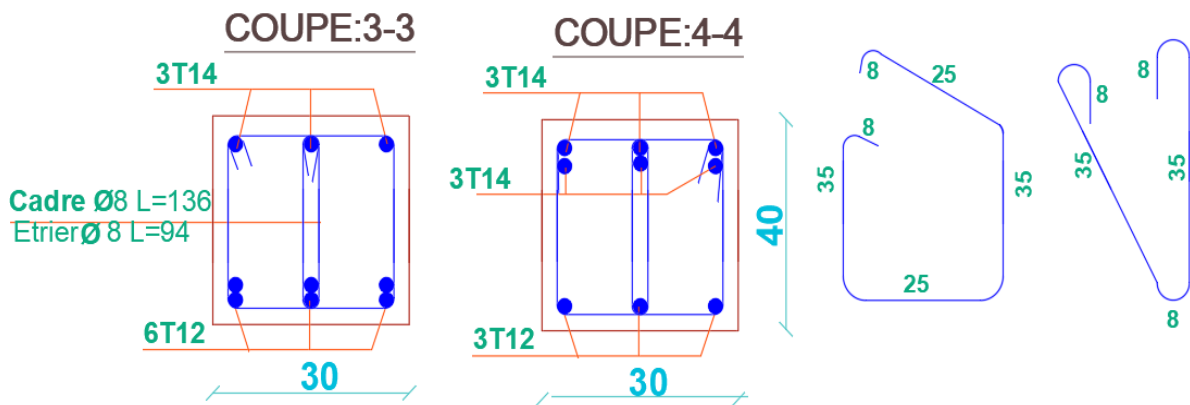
Ferrailage de la poutre secondaire (30× 40).
